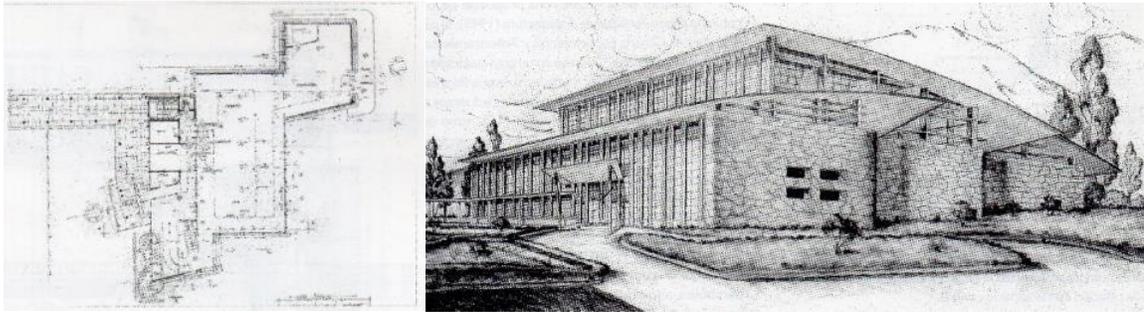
Planta y Perspectiva Edificio Imprenta. Fuente Arquitectura y Estado. Pag.279
